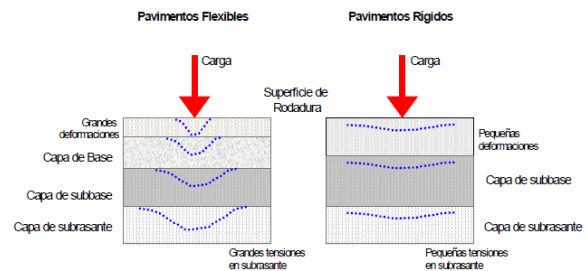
Esquema del comportamiento de pavimentos flexibles y rígidos.
